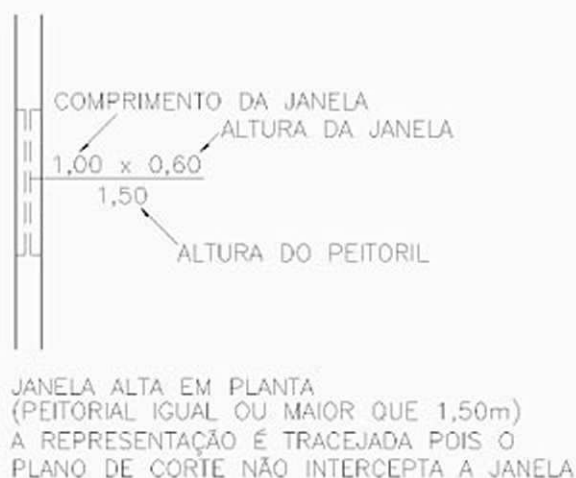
Janela alta em planta (peitoril maior ou igual a 1,50 m).
